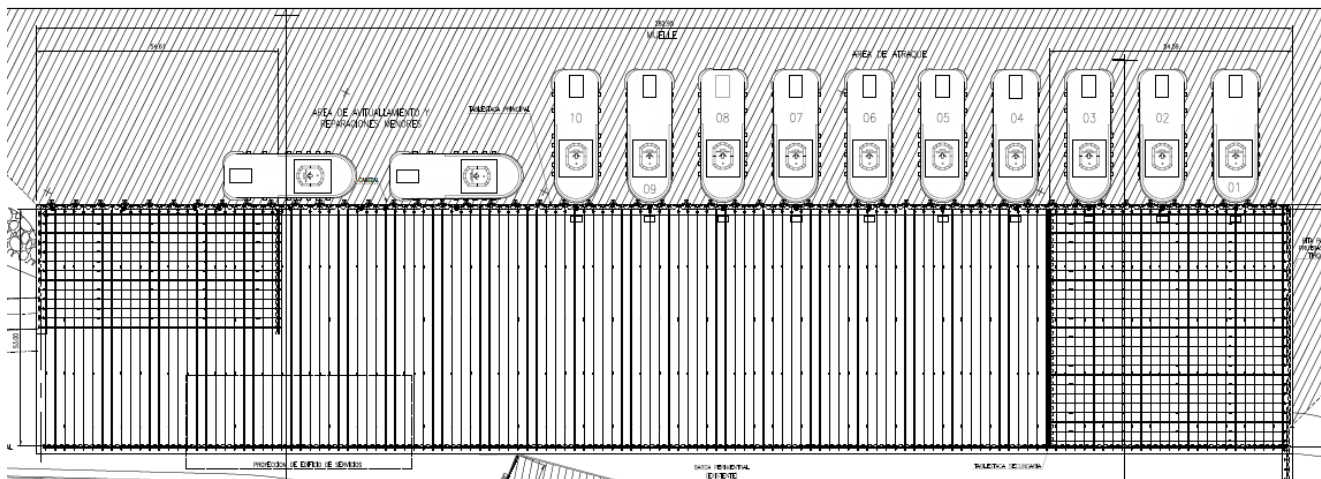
Longitud de colocación de la Tablestaca. Planta
